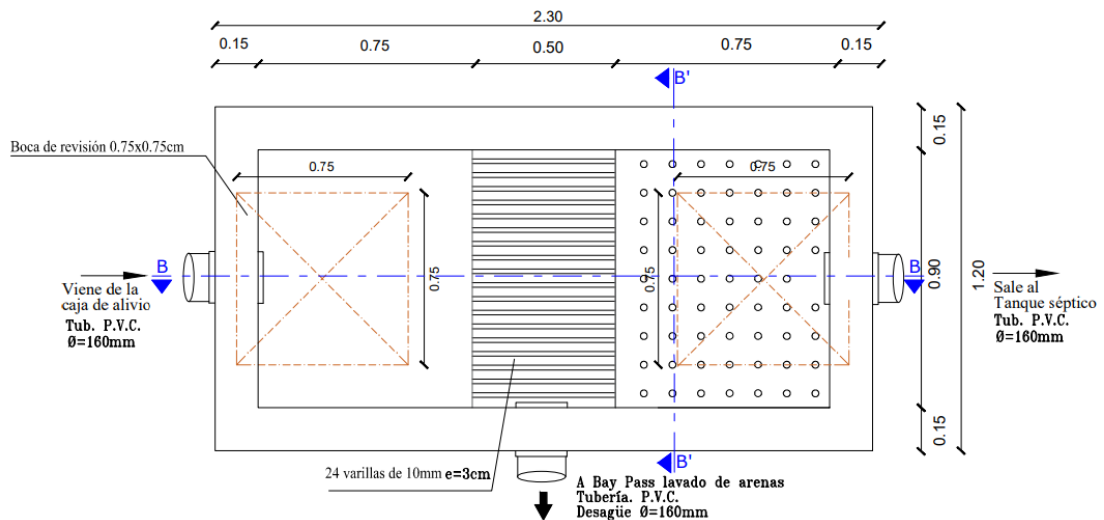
Corte Bz-Bz: Vista superior del cajón repartidor + criba
